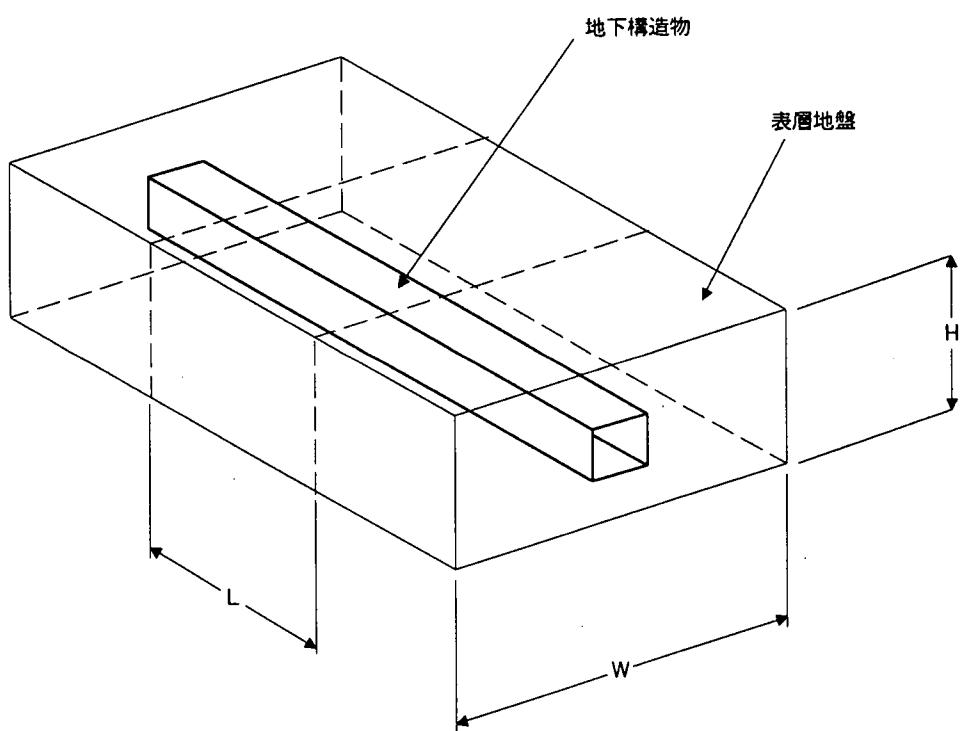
表層地盤のモデル化 (M 、 K_1 、 K_2)
